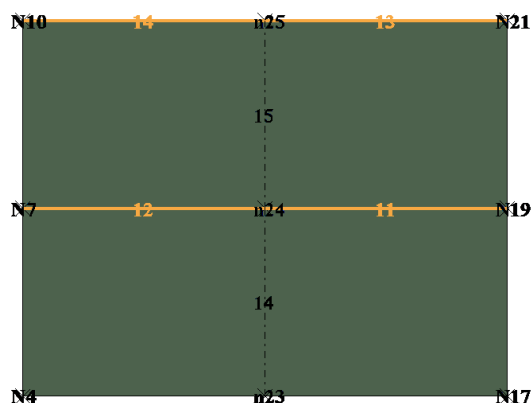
Prospetto Parete 4 - Modello Collegato
